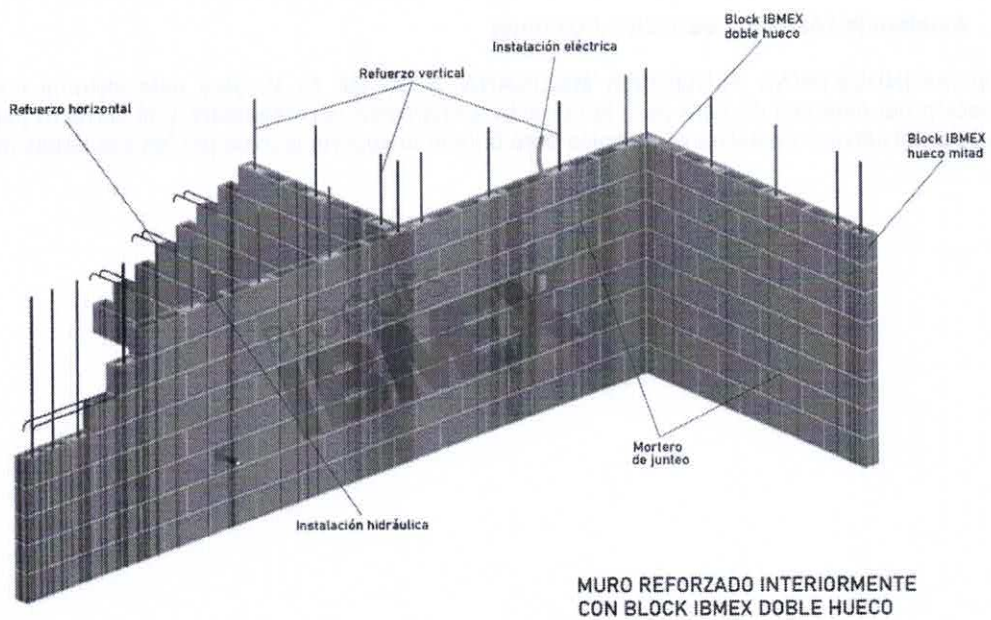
Aplicación del sistema de muros de block hueco reforzado interiormente
